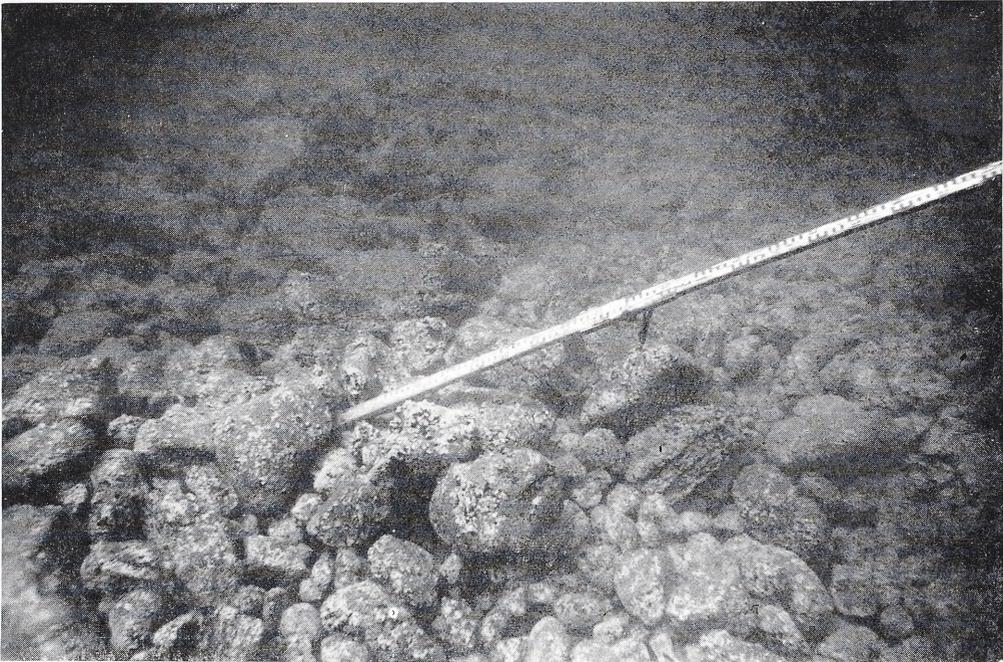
möge die Zusammensetzung dieser Steinschüttung illustrieren.
